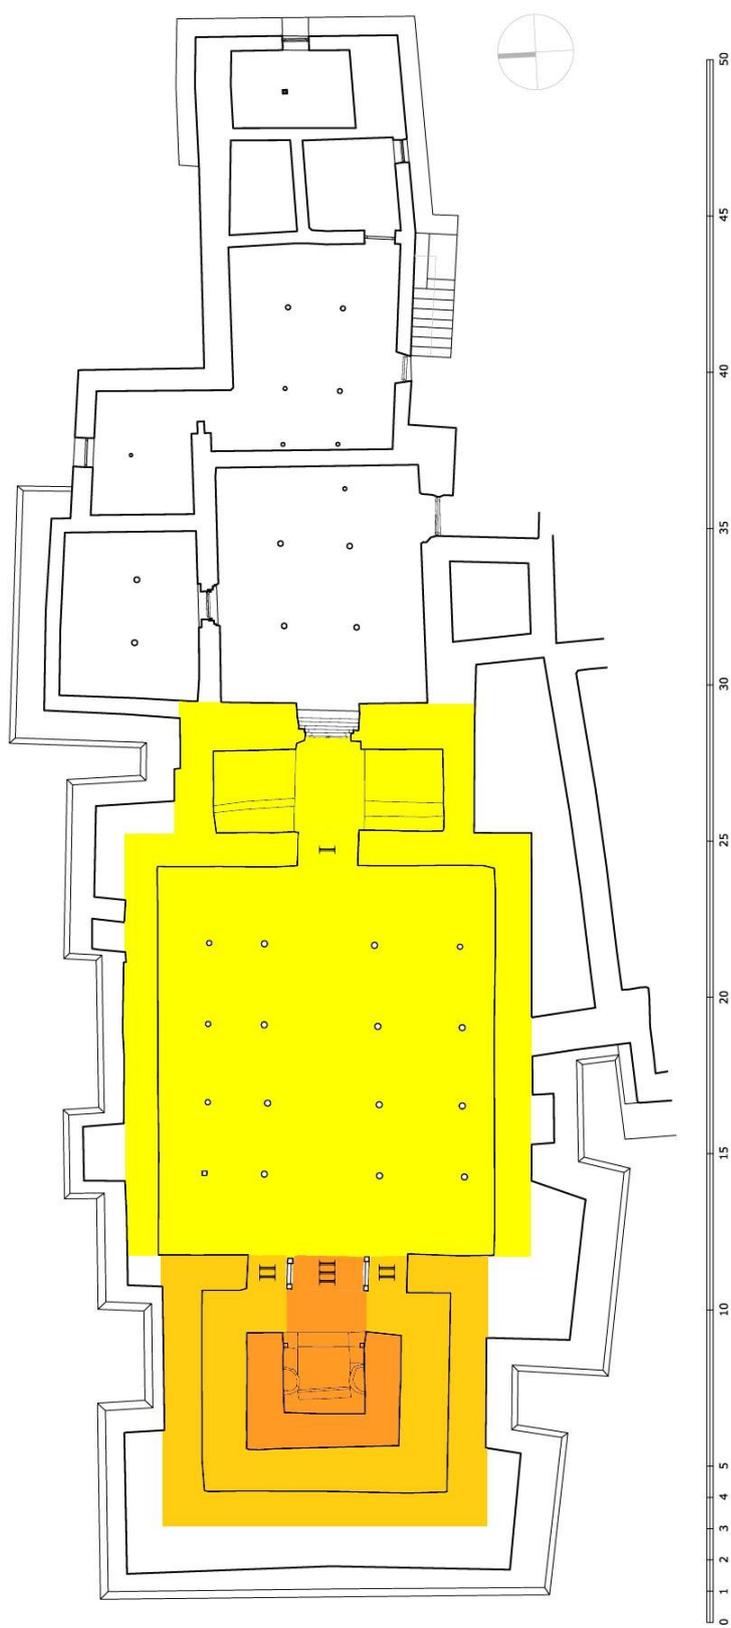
Gebäudegrundriss mit Durchgang I, II und III, *gtsug lag khang*, Tabo.
